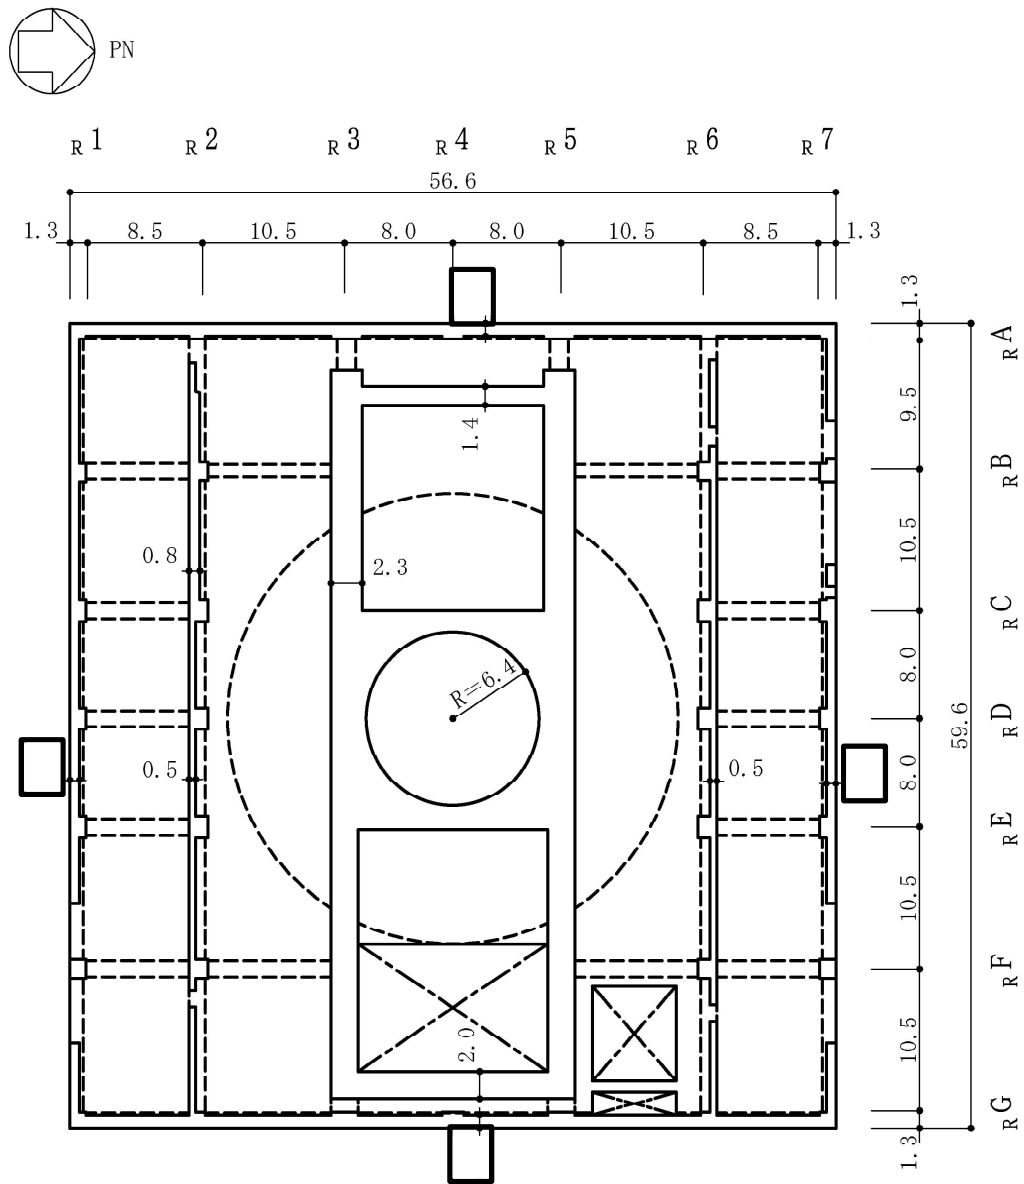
原子炉建屋の概略平面図 (3F, T.M.S.L. 23.5m) (6/9) (単位 : m)
